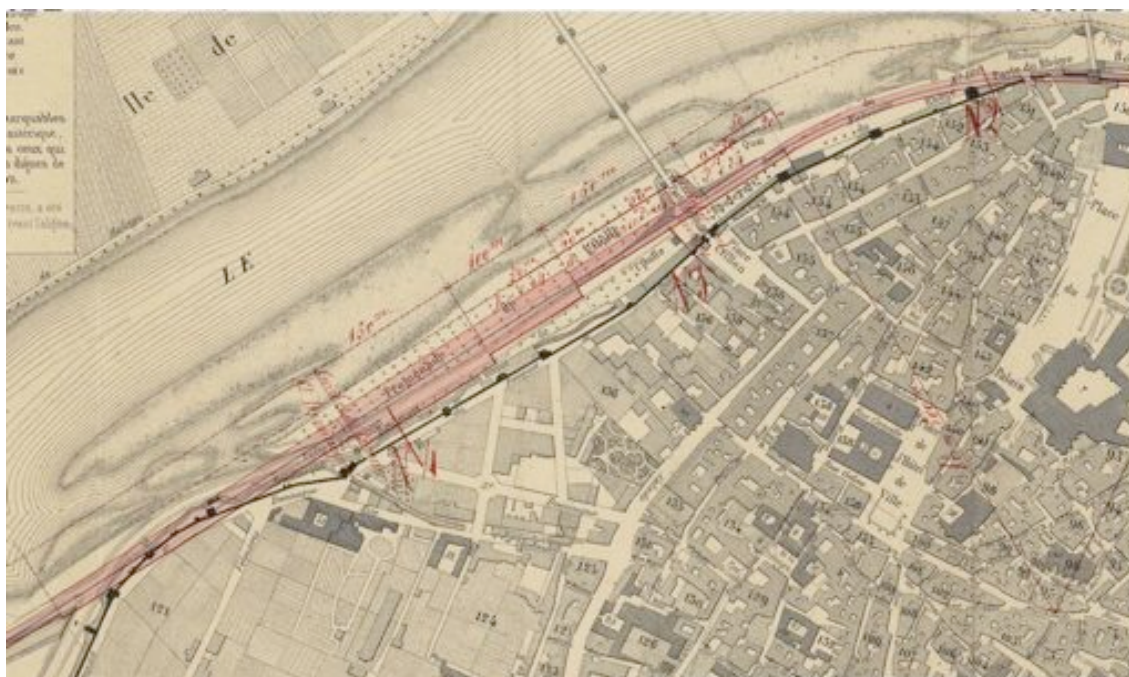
Détail plan d'Avignon sur le quel a été tracé la gare du chemin de fer sur les Allées de l'Oulle – 1848 - (AMA)
